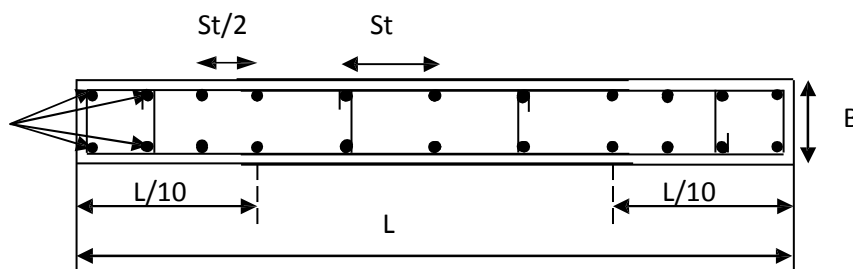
Schéma d'une coupe horizontale d'un voile
